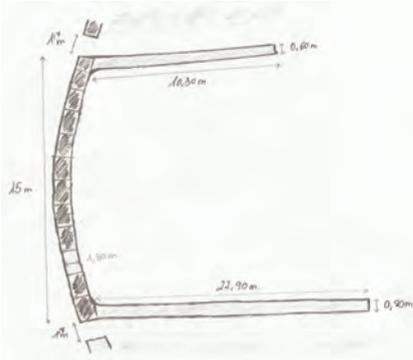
Croquis de la planta del complejo hidráulico Azud de Guadalupe.
